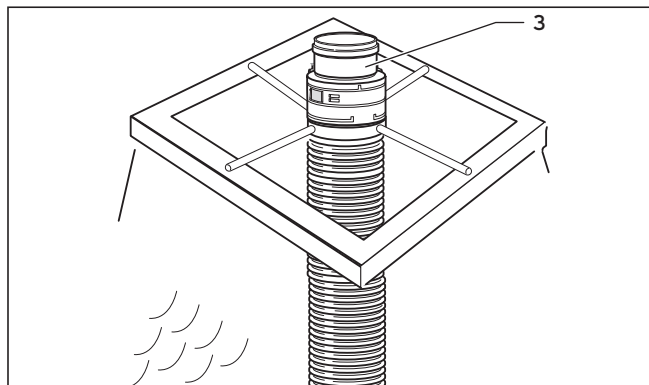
Élément de raccordement avec conduit des fumées flexible
